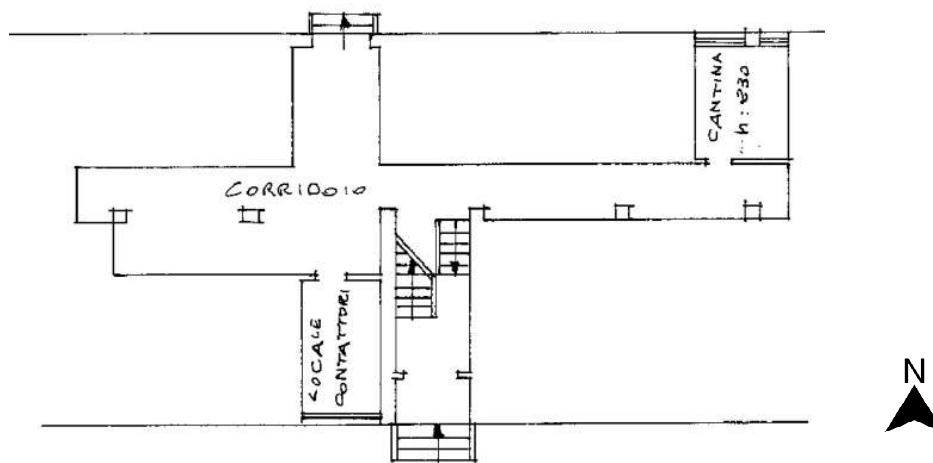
Planimetria catastale piano seminterrato – stato approvato
